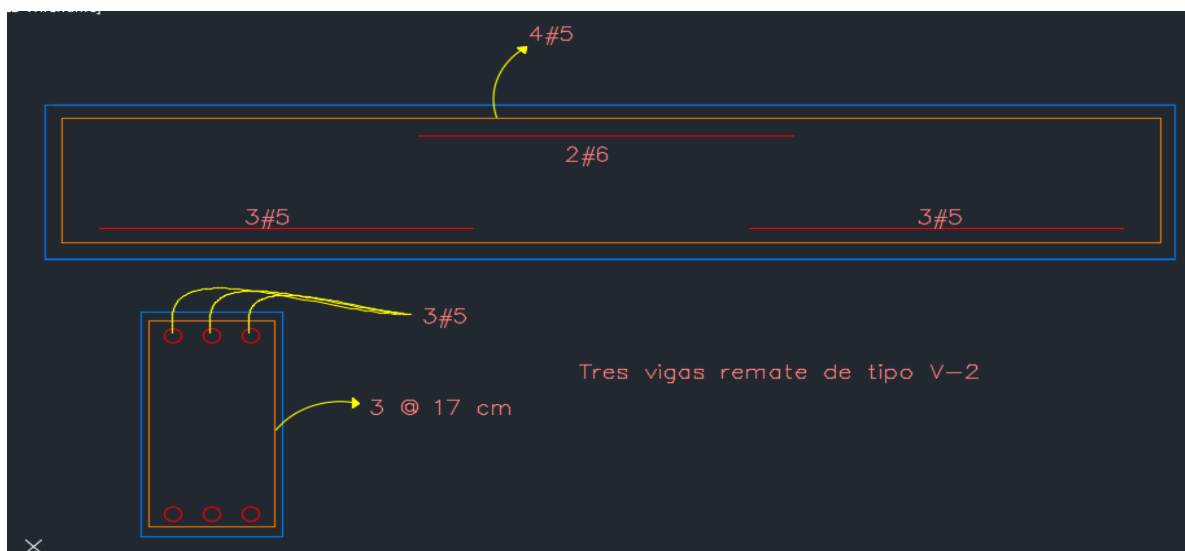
DETALLE DE VIGA REMATE TIPO V-2
